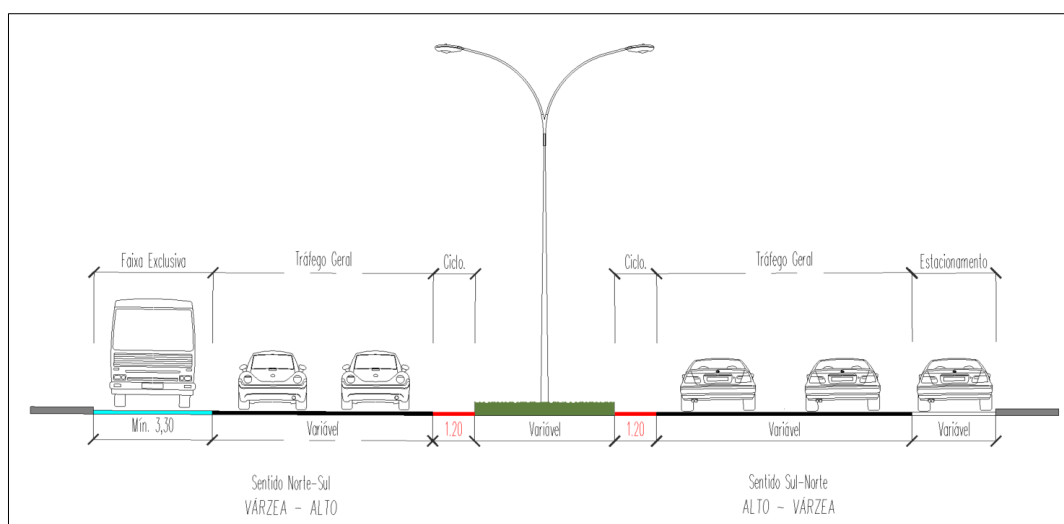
Configuração viária proposta para faixa exclusiva – Eixo Reta
